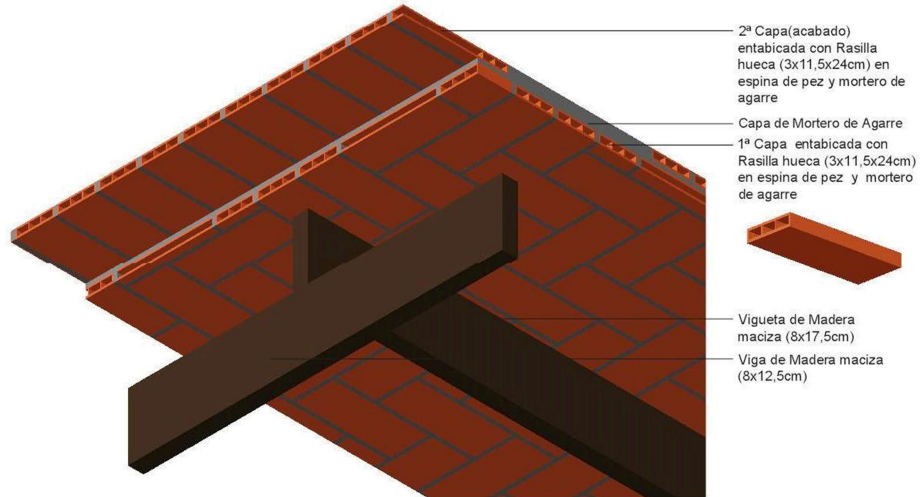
Detalle de forjado entabicado de doble capa de rasilla hueca con viguetas de madera
